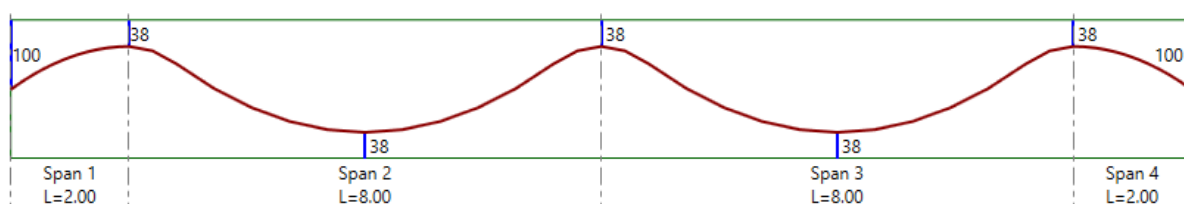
Traçado dos cabos em elevação (Autor, 2019)
